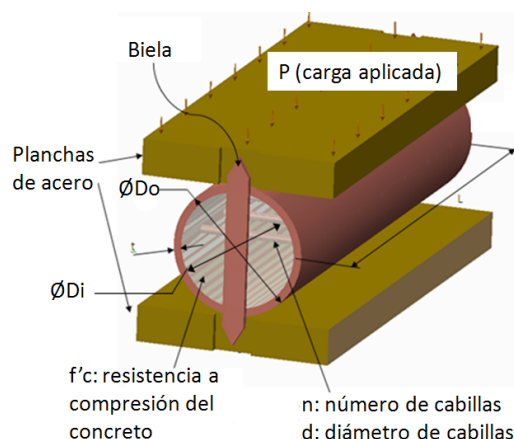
Configuración geométrica del sistema apoyo móvil – planchas del PGRU.
